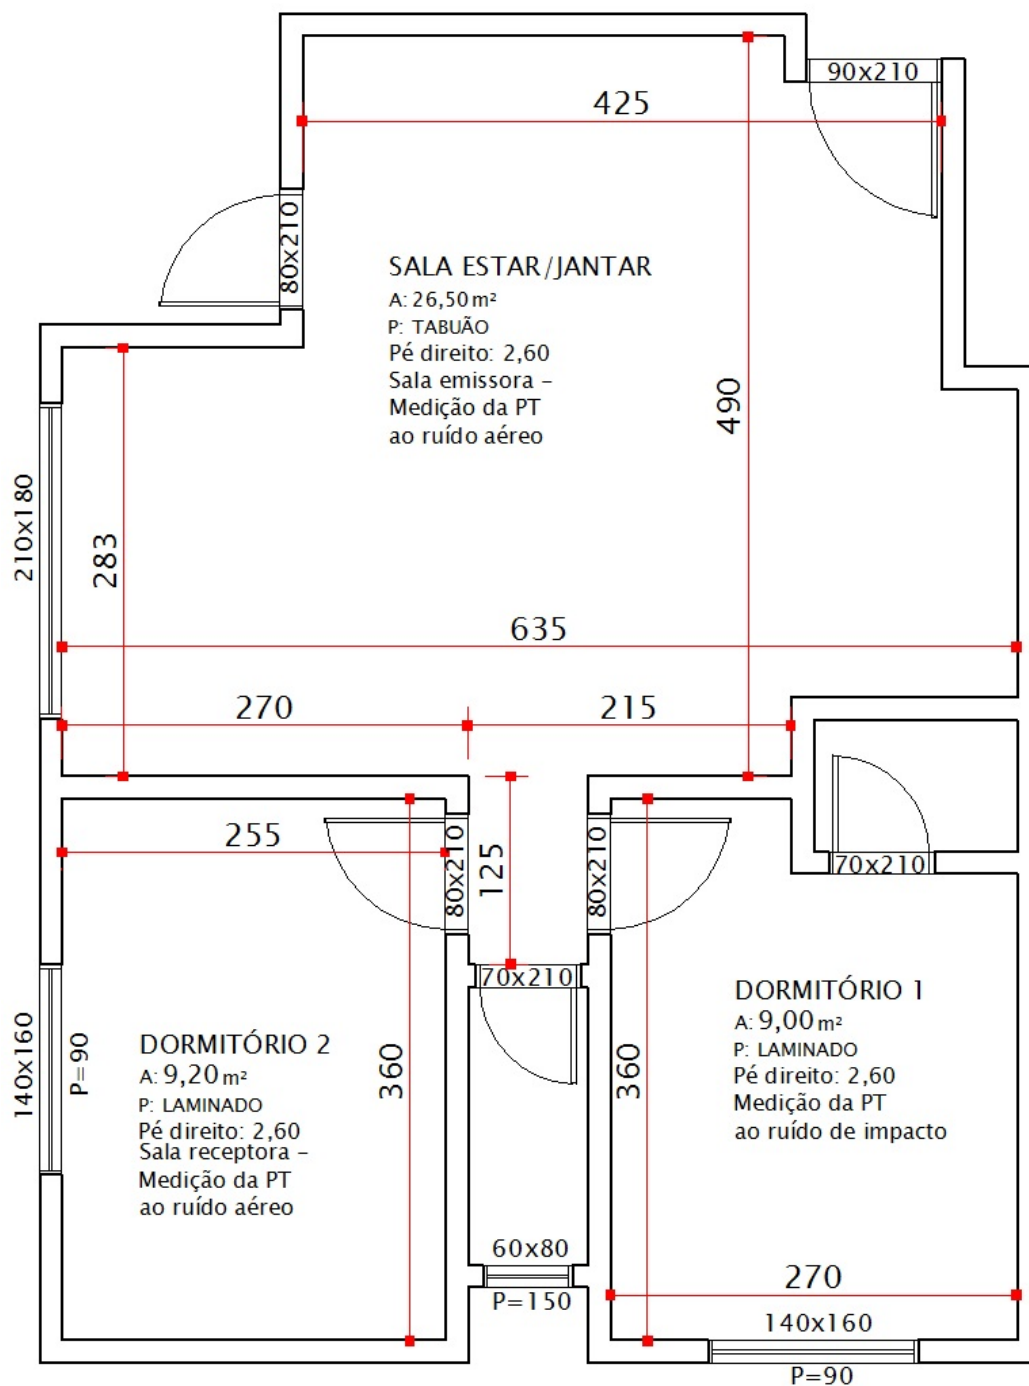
Planta baixa - pavimento tipo - 09-R8-N-BCE-PL
